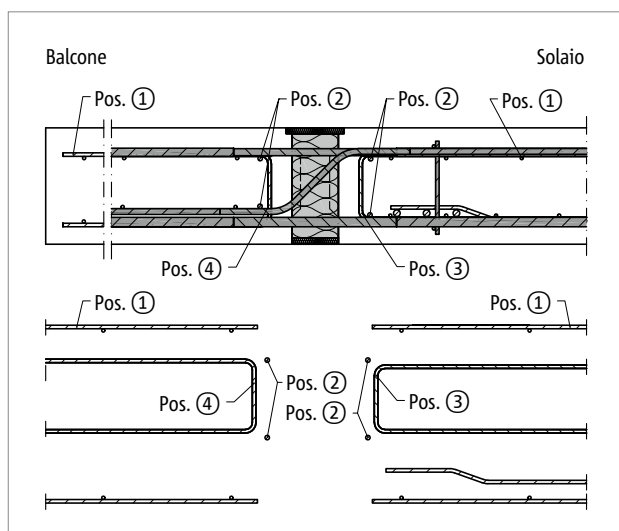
Schöck Isokorb® T tipo KP-M13 – M14: armatura in opera con appoggio indiretto
